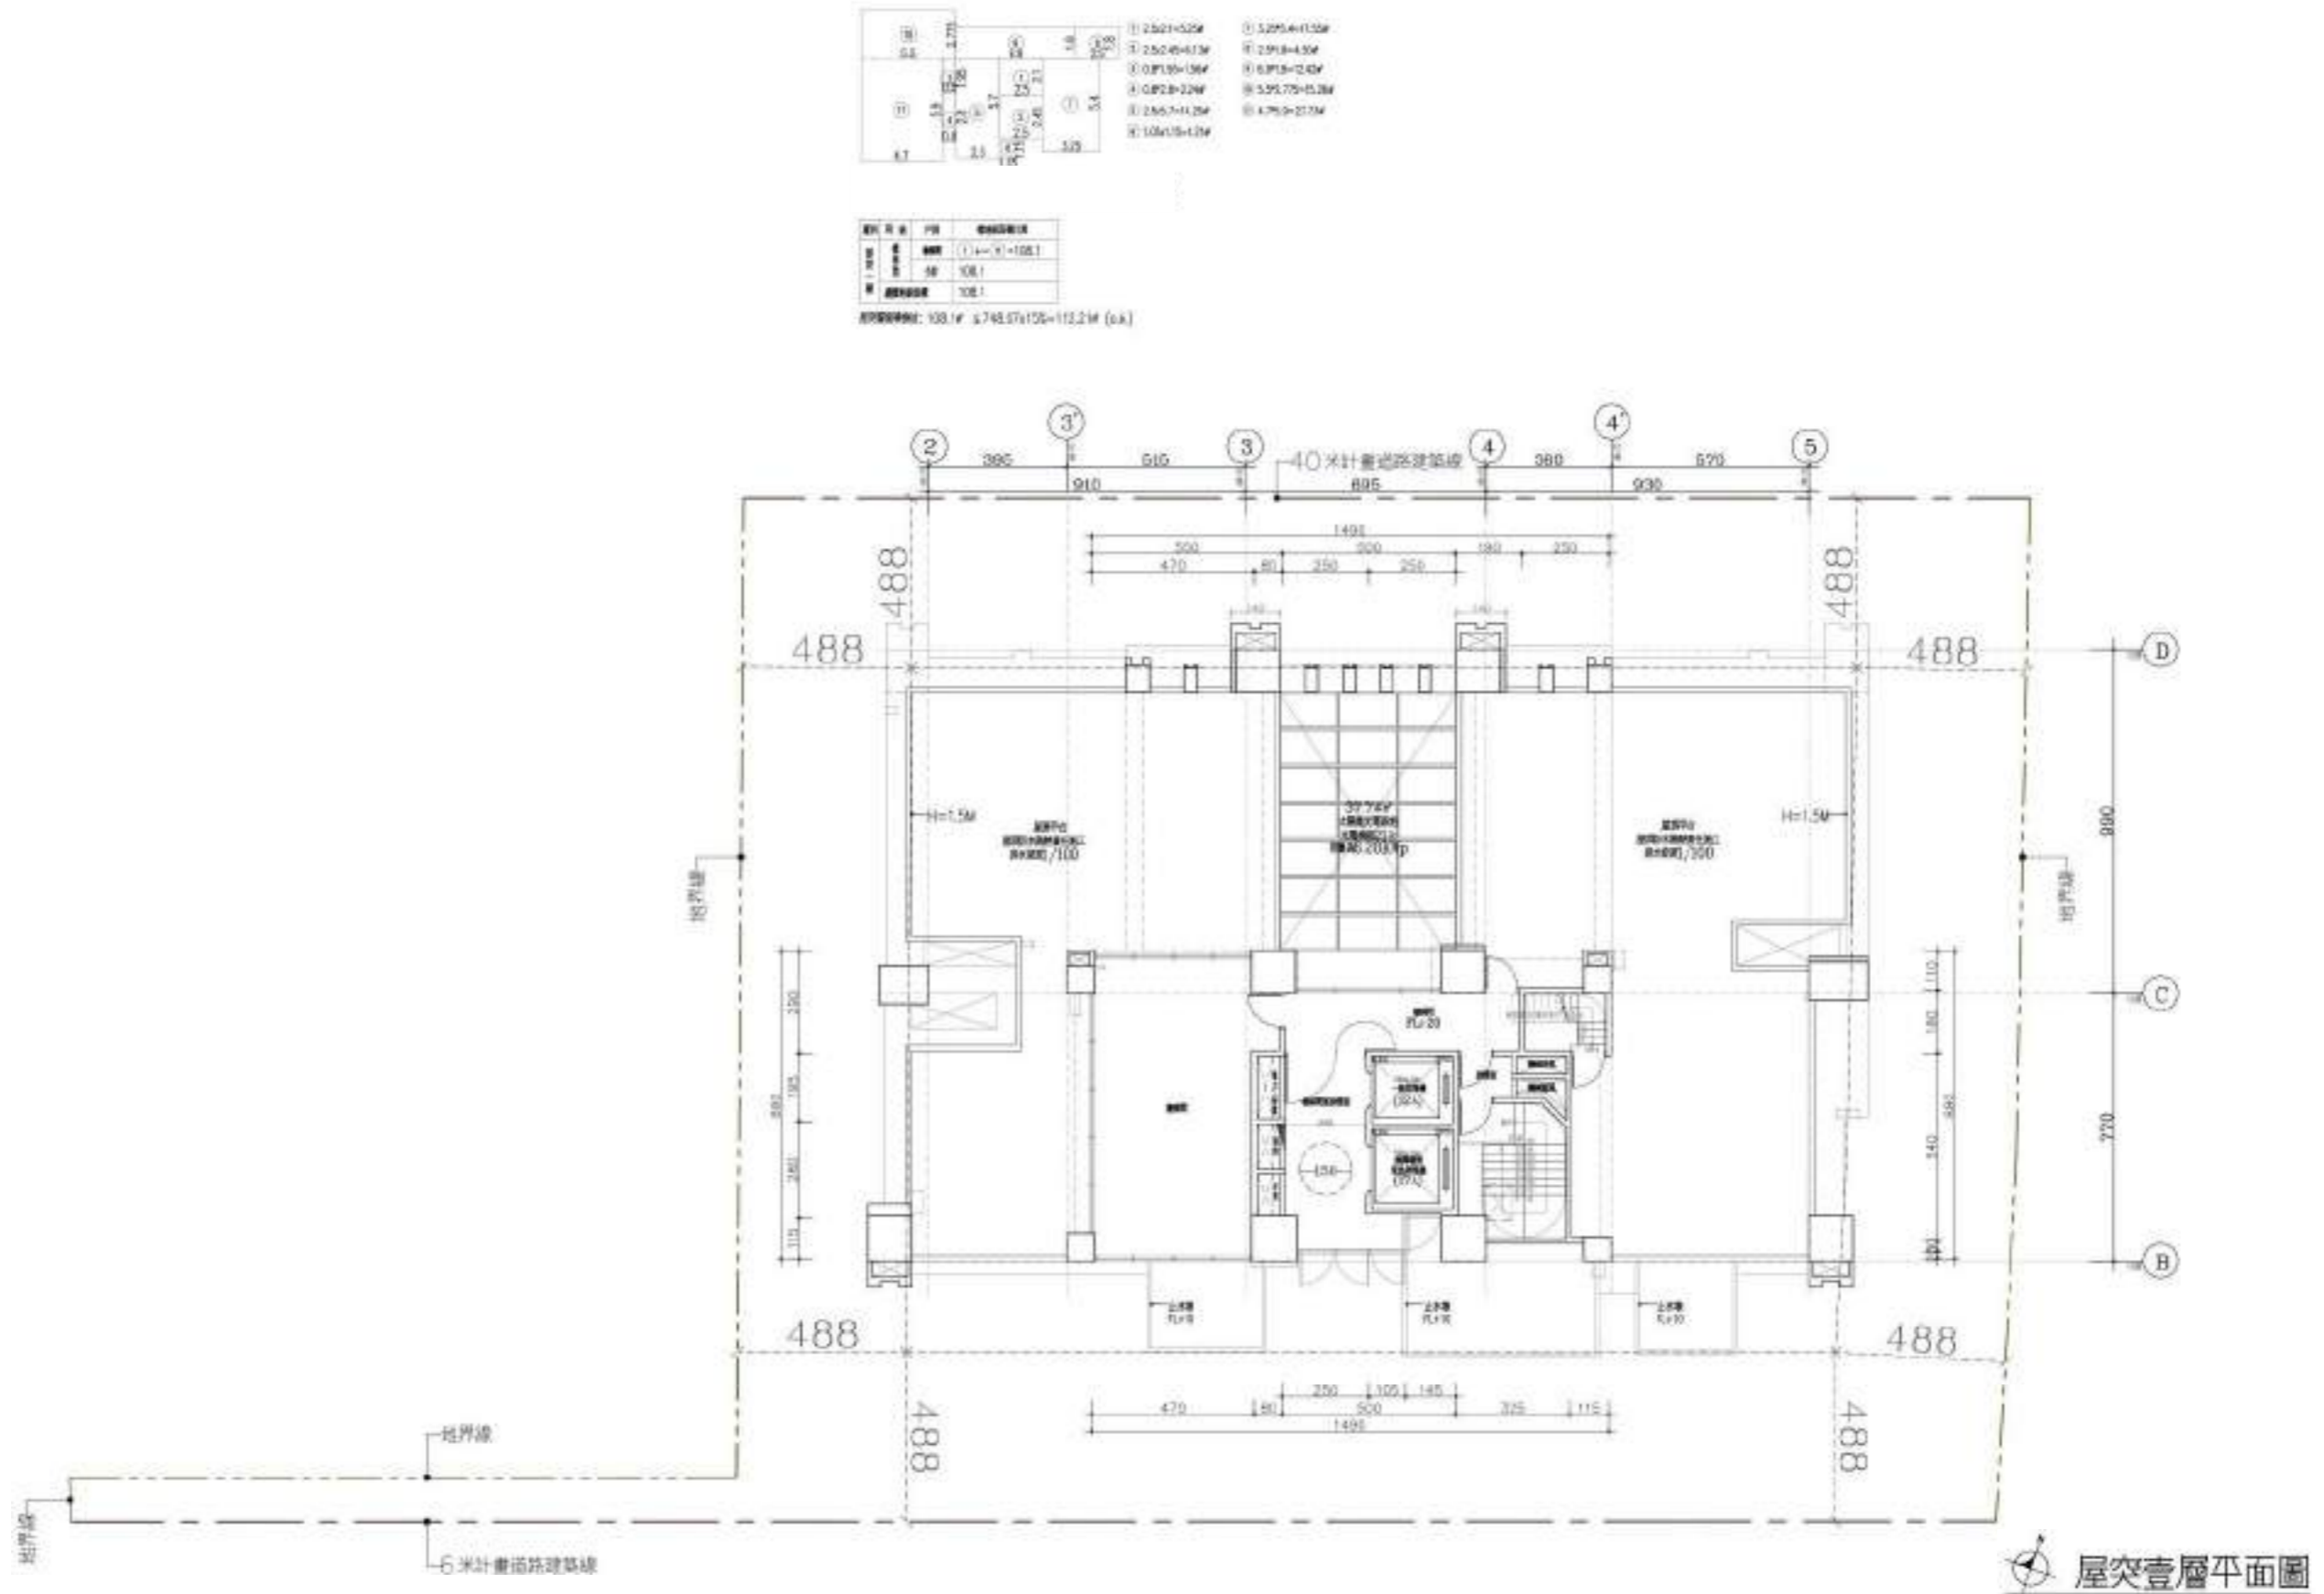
屋突一層平面圖 (比例尺 1/200)
